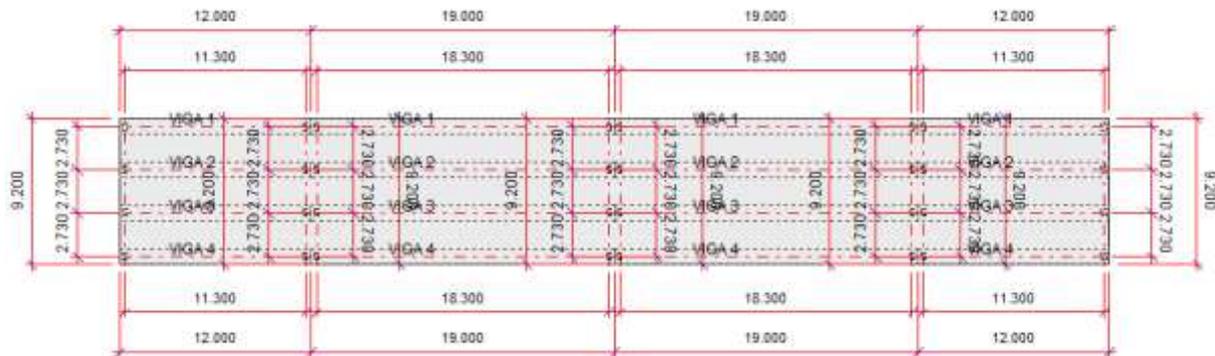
Vista en planta del tablero. Fuente: El. prop.
